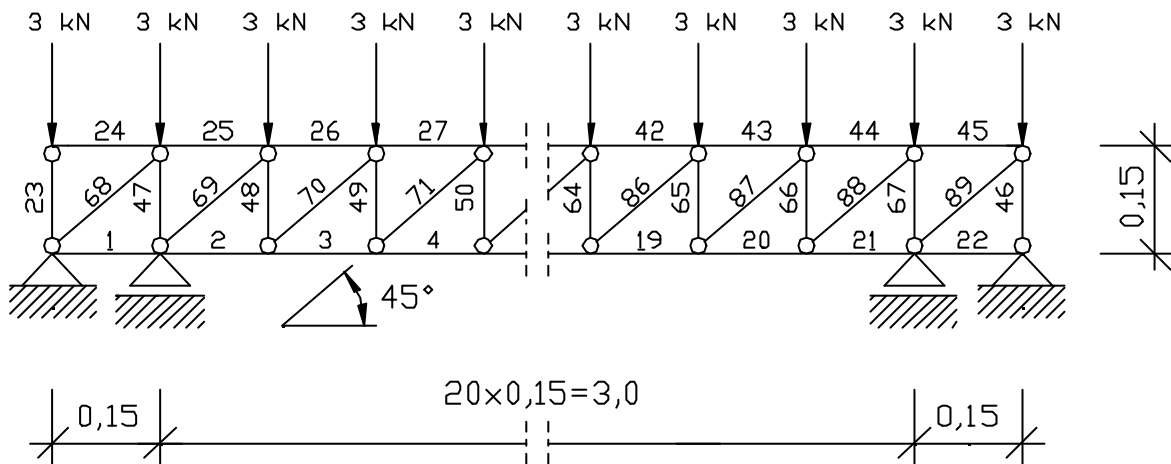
Ersatzmodell mit Stabnummerierung für Brettlagenholz mit diagonaler Struktur
